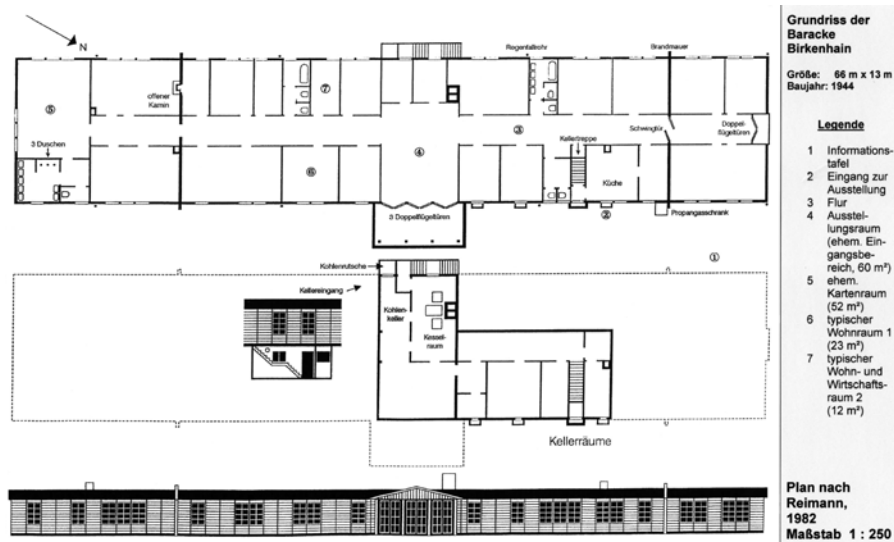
Grundriss der Baracke nach Reichmann, 1982
